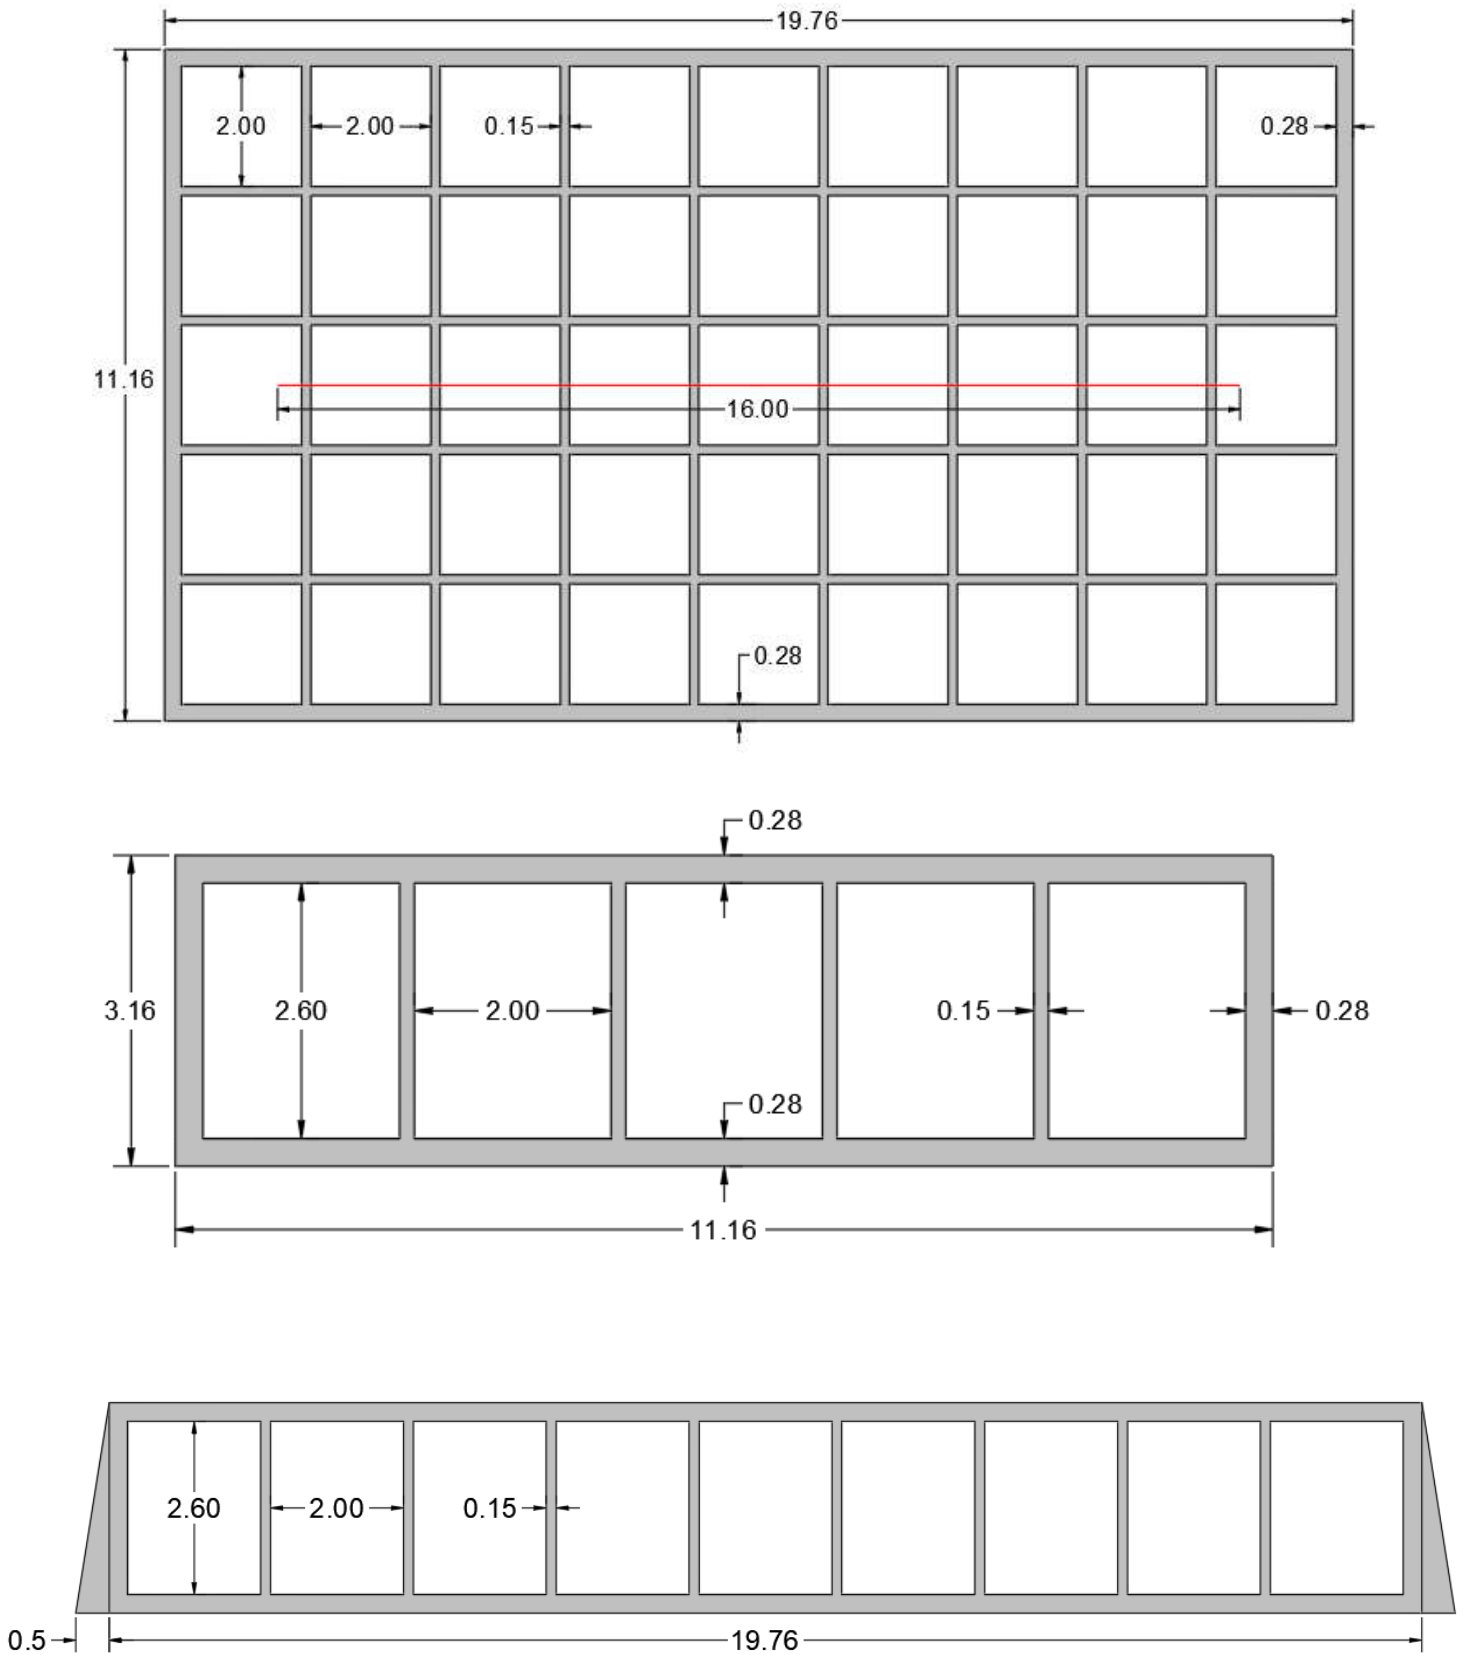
Dimensioni del cassone progettato, in ordine pianta, sezione trasversale e sezione longitudinale
